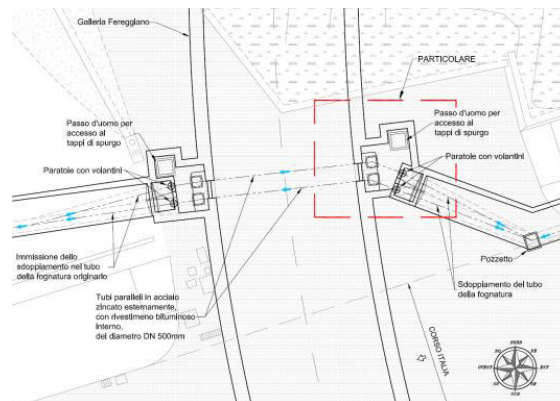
Vista in pianta dell'intersezione tra fognatura di C.so Italia e galleria Fereggiano
